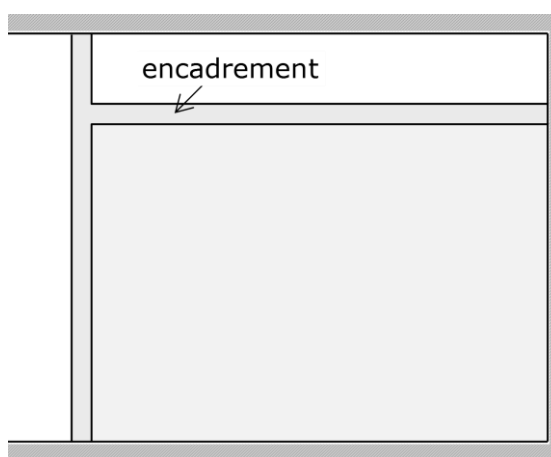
encadrement des cloisons n'atteignant pas le plafond
